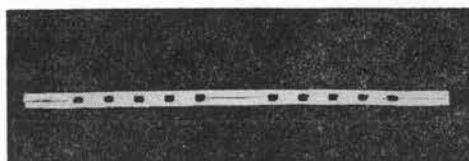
ペーパードレーン用紙断面 (100×3 mm)
